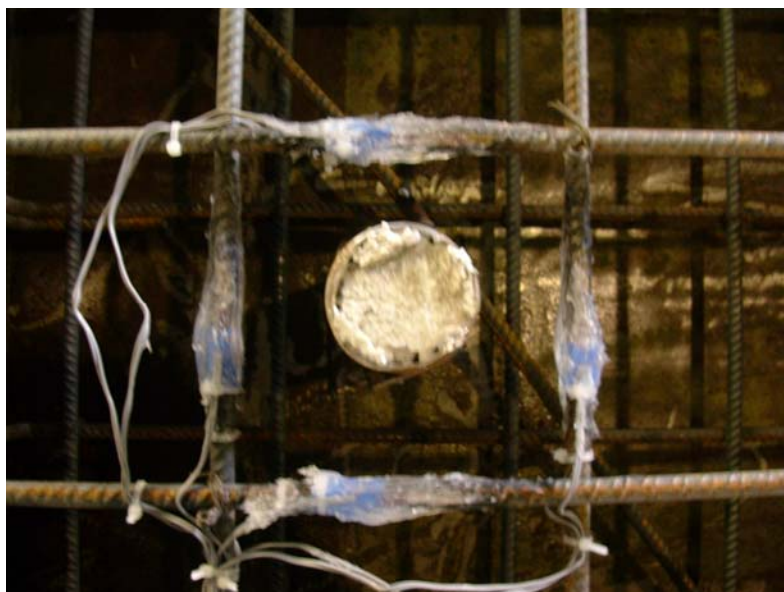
Pormenor da localização dos extensómetros na armadura
